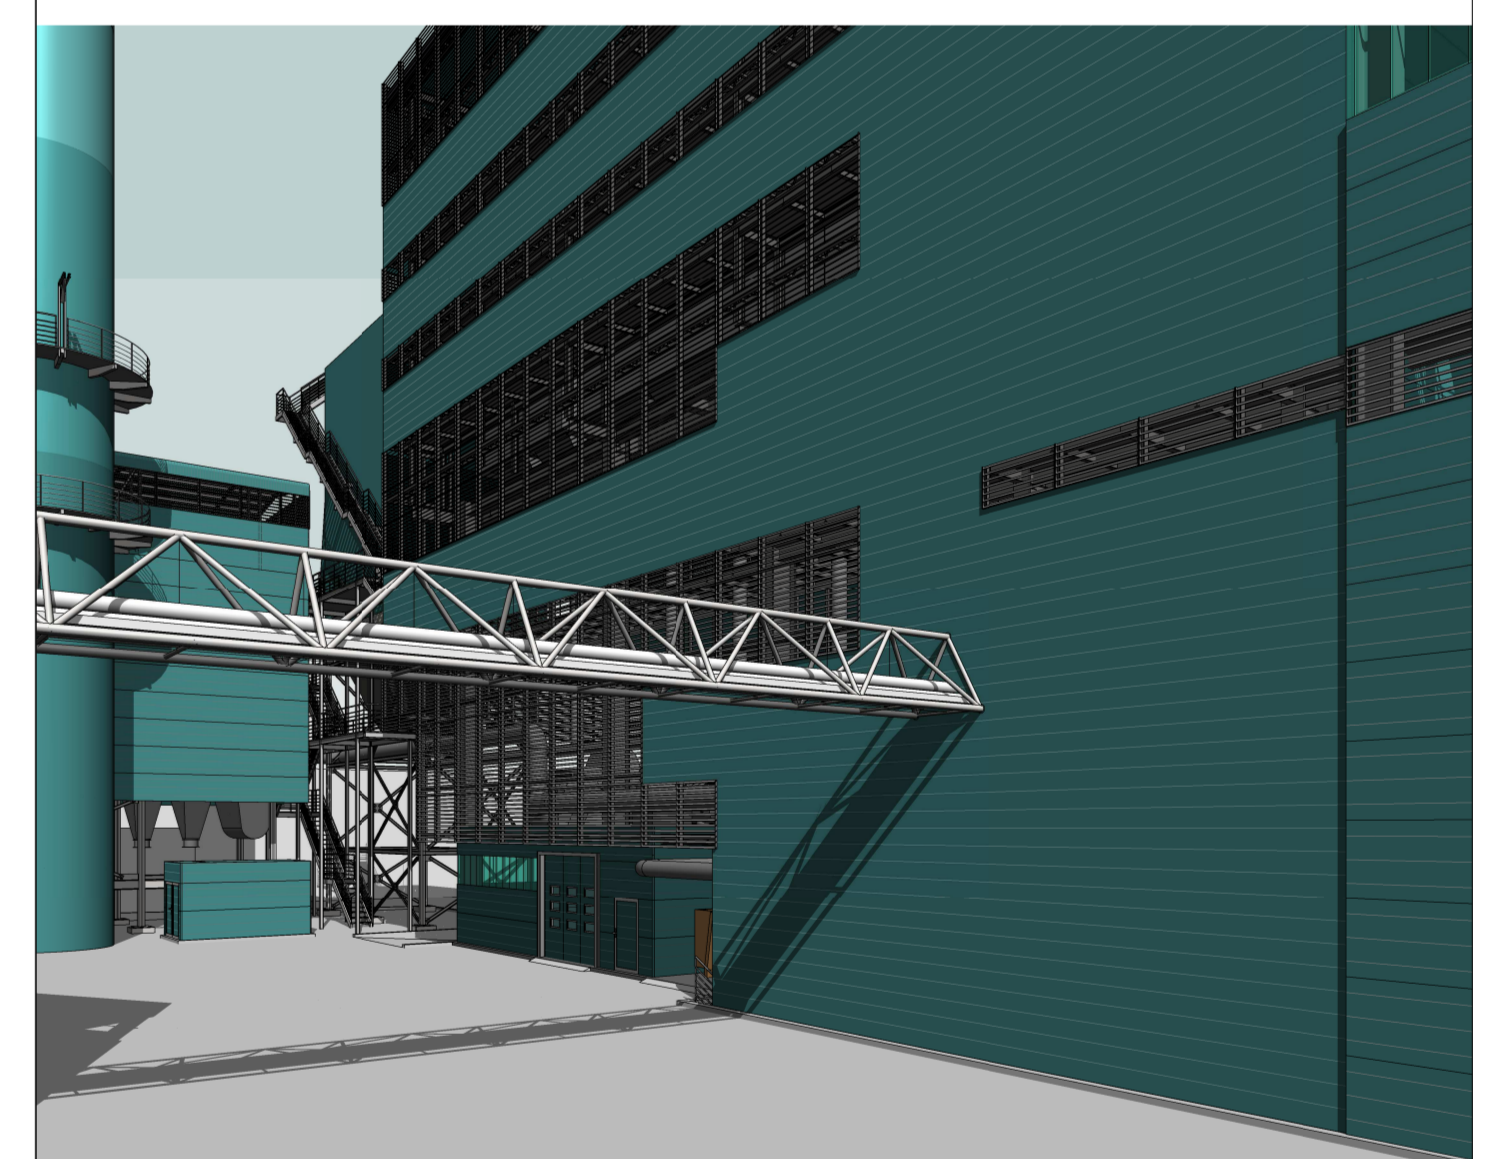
Vista prospettica dell'Edificio Caldai dal piazzale interno
